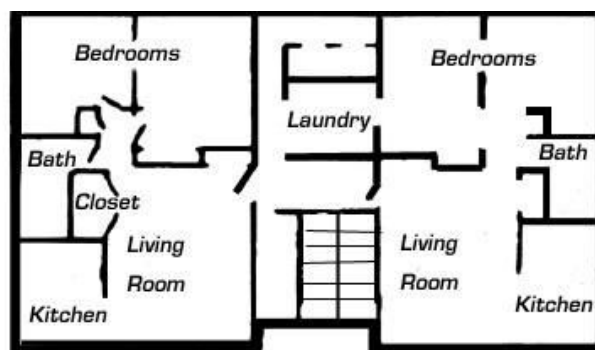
Planta baixa tipo bloco 2 pavimentos (RESCOLLEGE, 2010).
